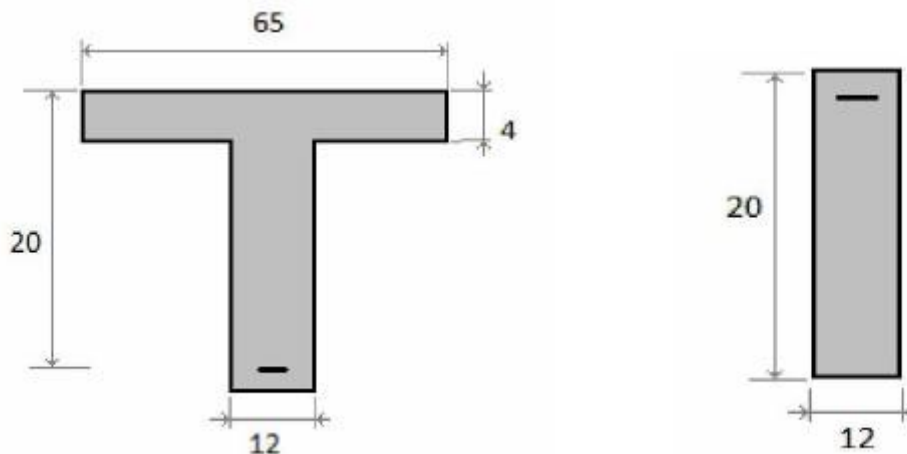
les sections considérées pour le calcul de ferrailage en travée ( à gauche ) et en appui ( à droite )
